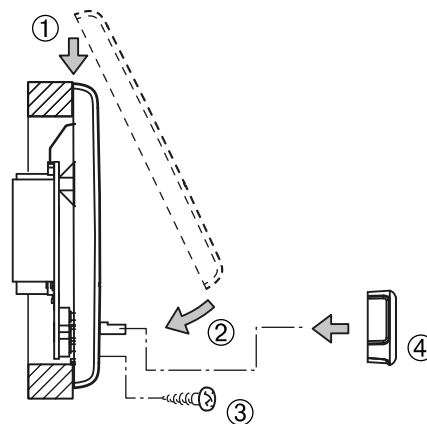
Monter la partie supérieure de pièce de commande et le bouton rotatif/poussoir
